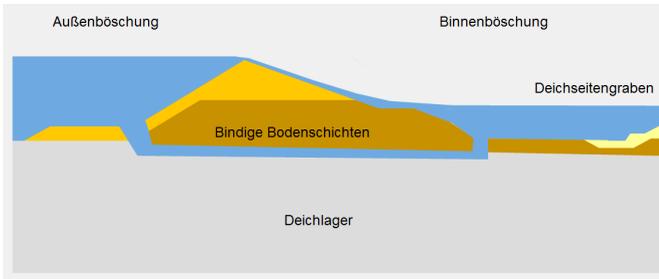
Versagensfall – Hydraulischer Grundbruch [1].
